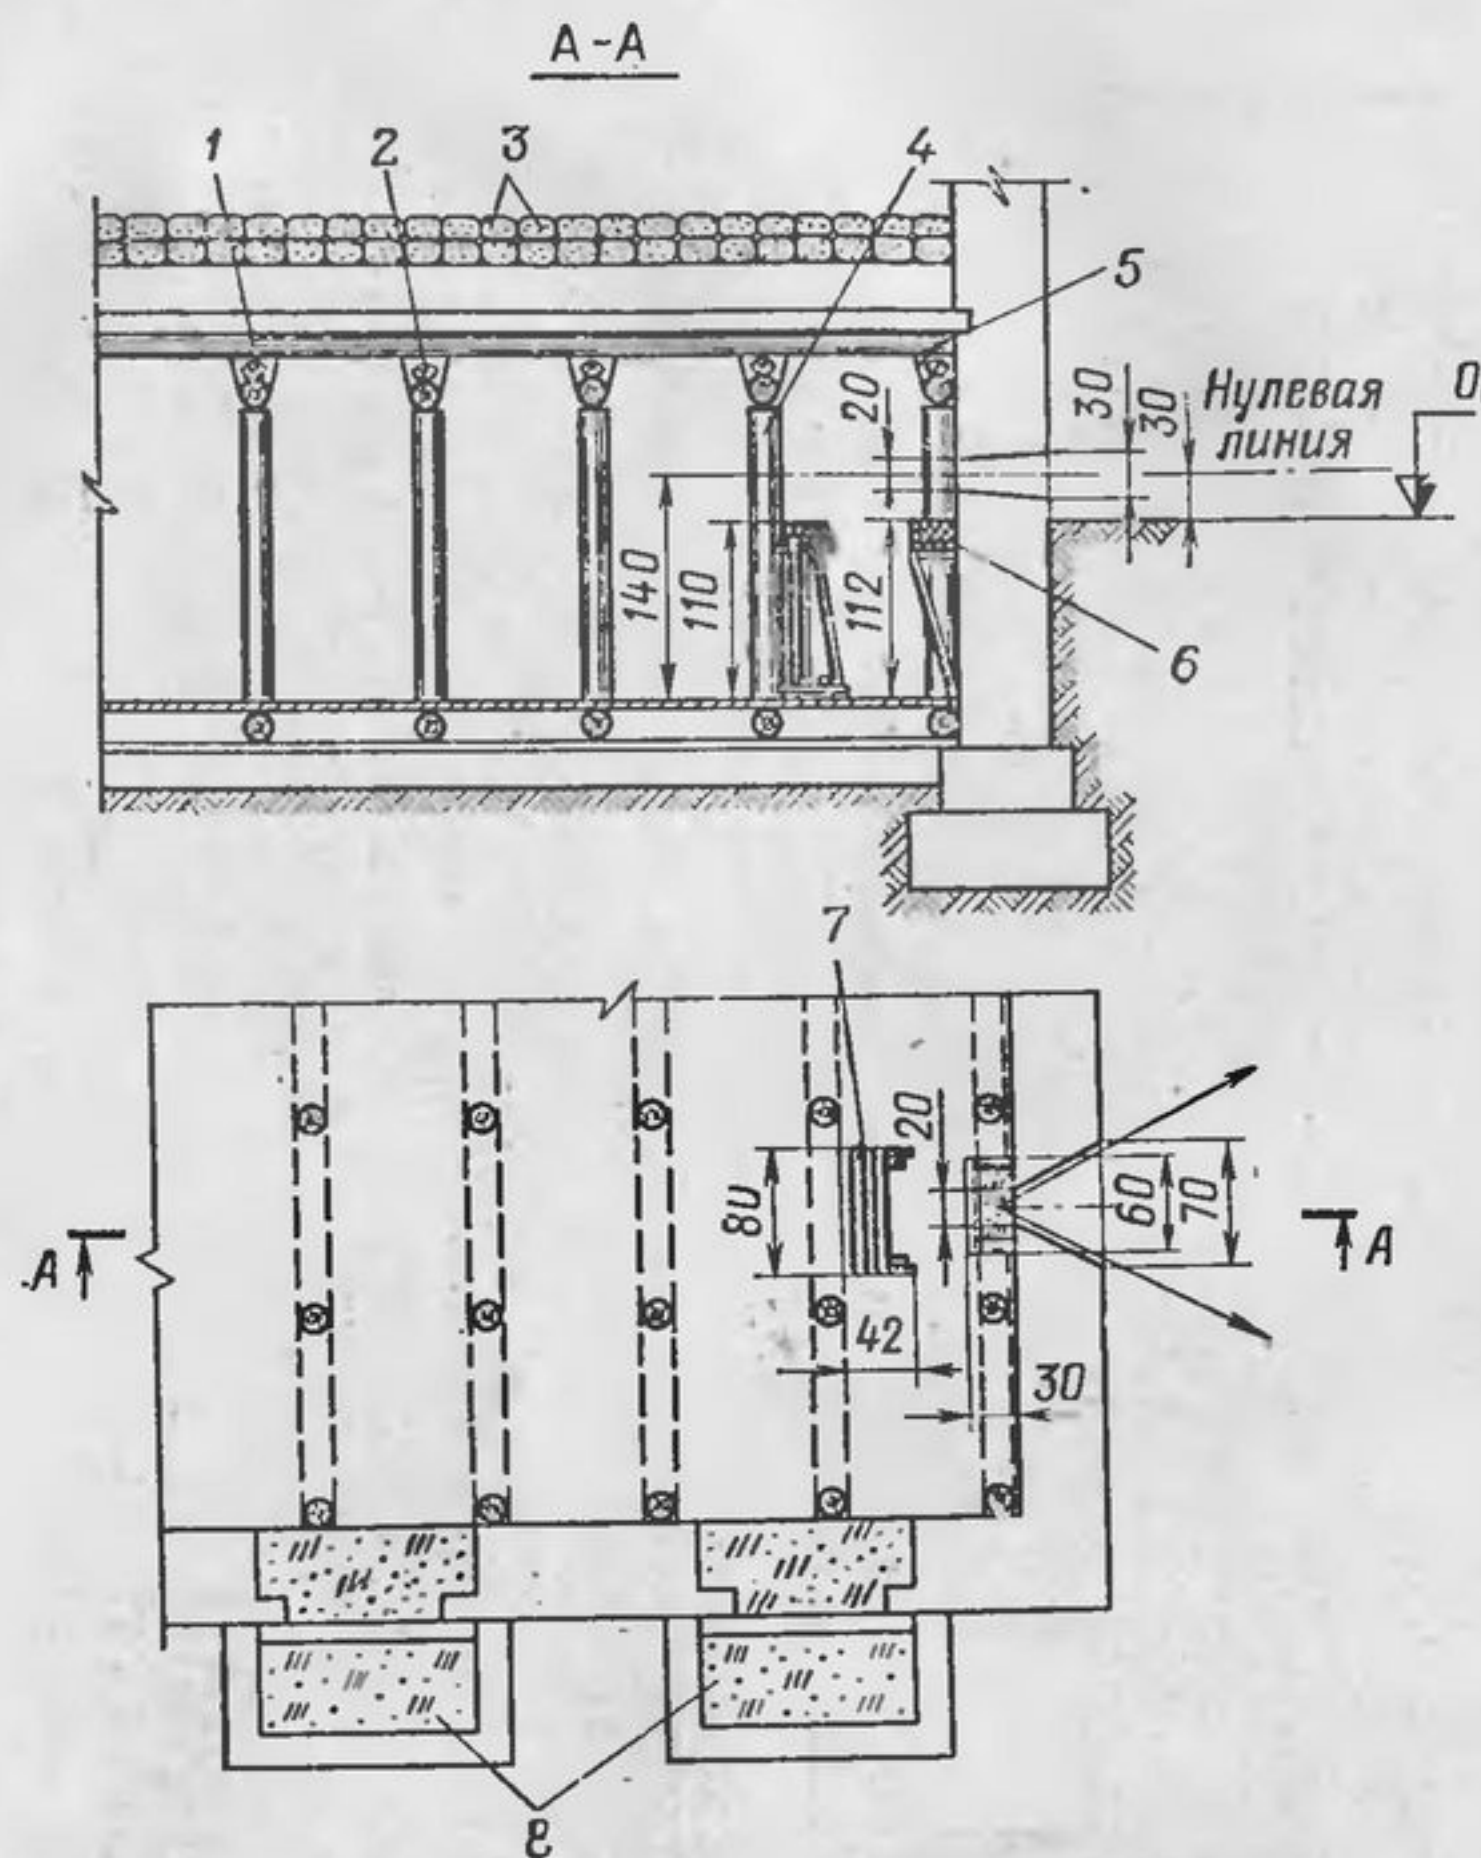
Приспособление подвала здания для стрельбы из пулемета:
